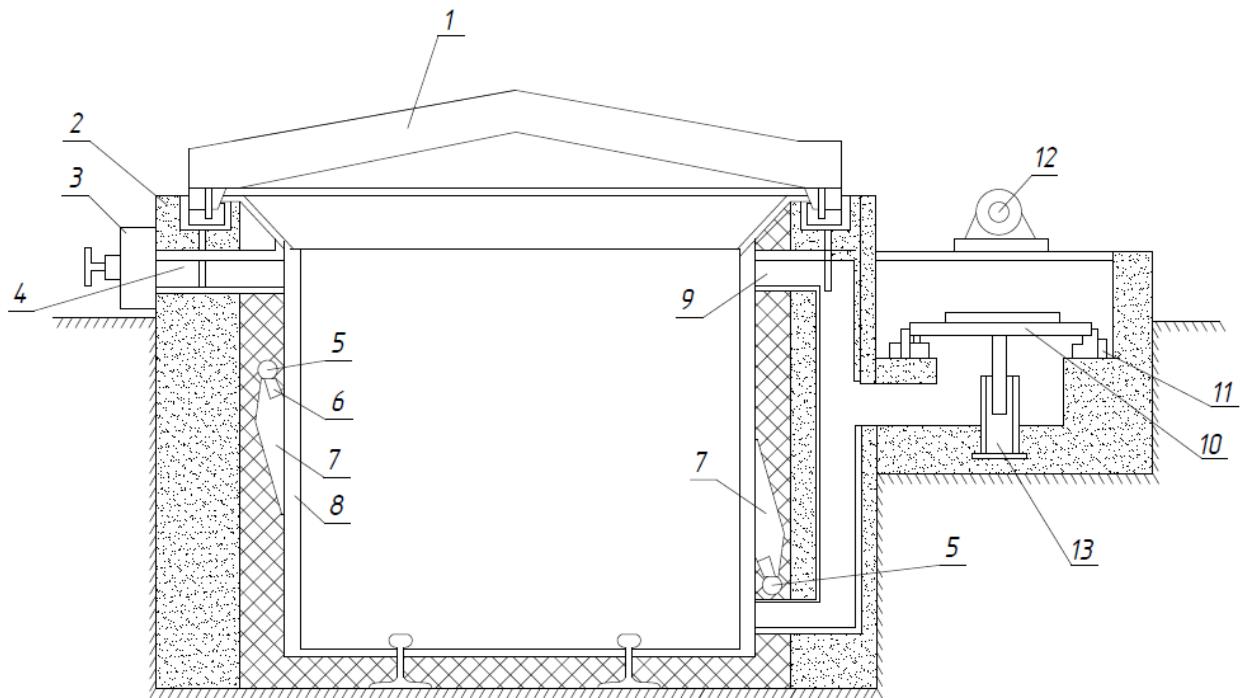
Общий вид ямной камеры ТВО: 1 – Крышка камеры; 2 – Гидрозатвор камеры; 3 – Вентиляционное отверстие; 4 – Крышка вентотверстия с уплотнителем; 5 – Распределительный паропровод; 6 – Паровыпускное устройство; 7 – Ниши для паровыпускного устройства; 8 – Защитные рёбра; 9 – Вентиляционный канал; 10 – Вентиляционный клапан; 11 – двойной гидрозатвор вентиляционного клапана; 12 – Привод вентиляционного клапана; 13 – Направляющая
